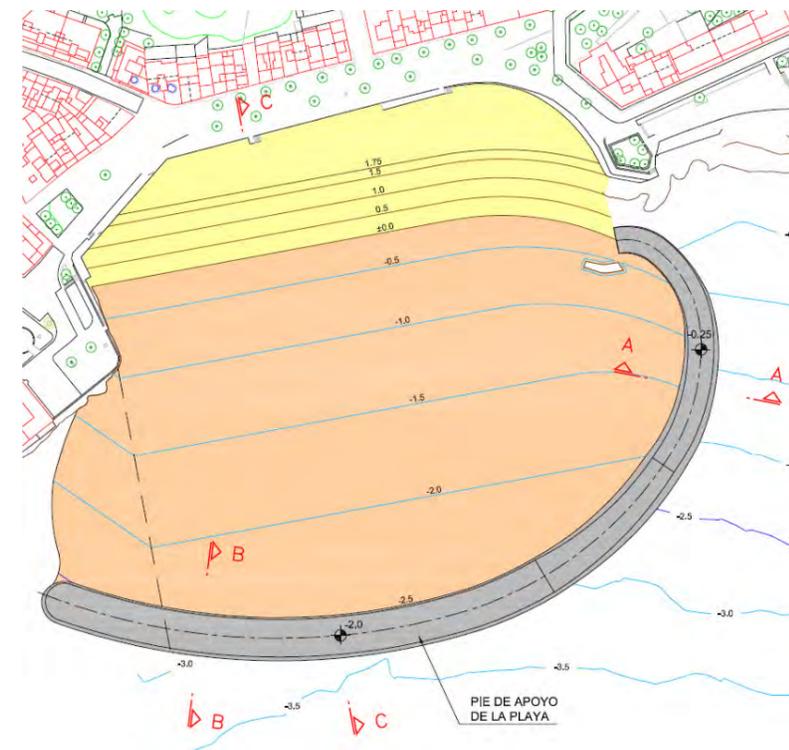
Planta de la Variante 1 de la Alternativa 2. (Fuente: Elaboración propia)
